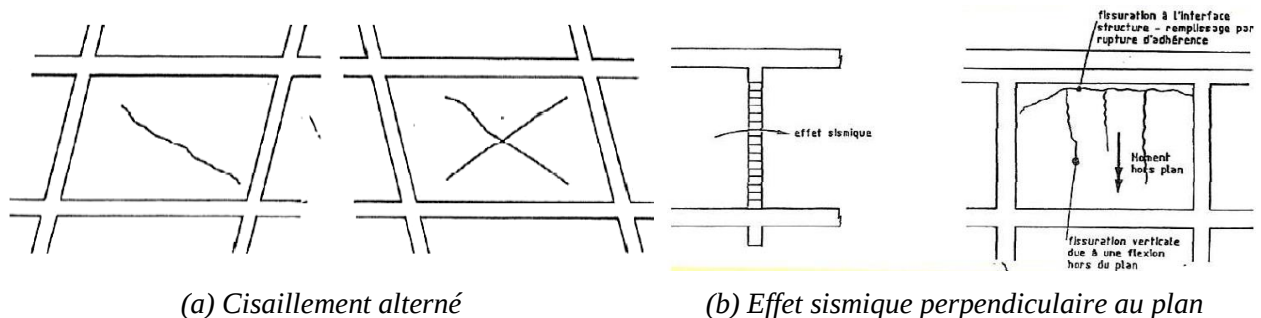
Fissurations du panneau de maçonnerie [20].
